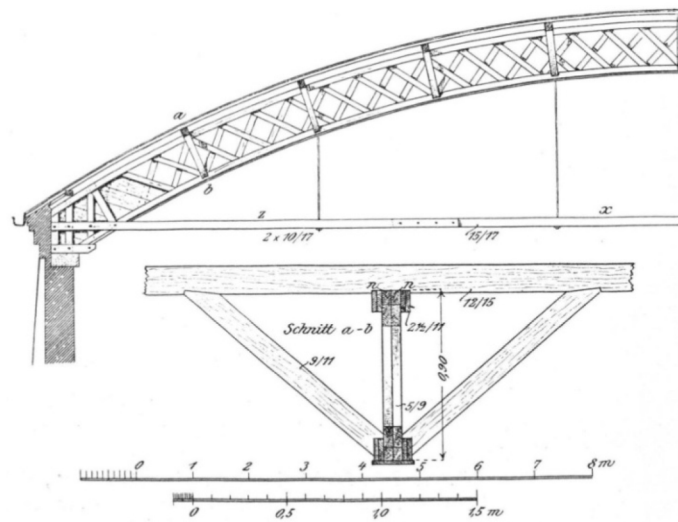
Bauweise Stephan mit hölzerner Zugstange [Kersten, 1926]
